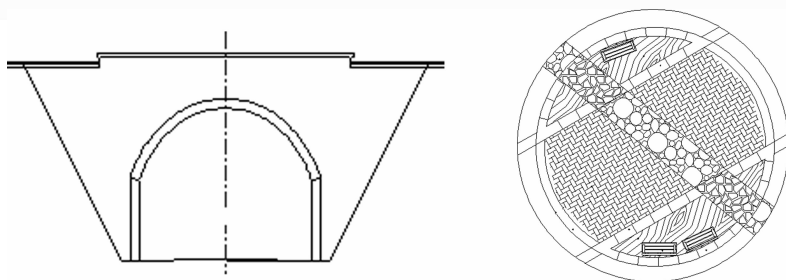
隧道施工图及园林平面图中圆和圆弧的使用
